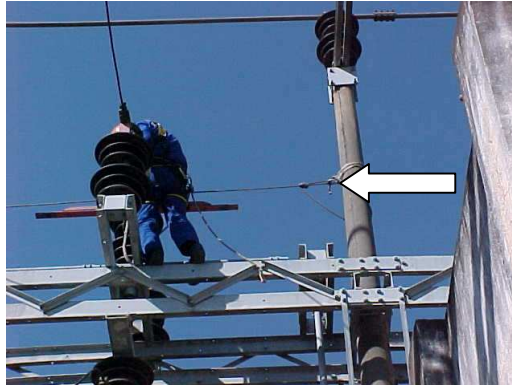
Detalhe do corrimão instalado em um dos cantos da estrutura
